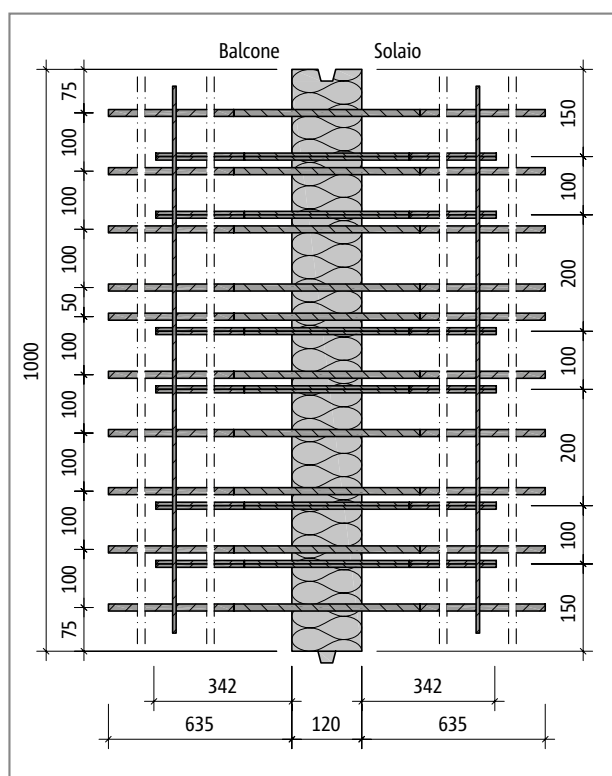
Schöck Isokorb® tipo DXT70-VV6: pianta
